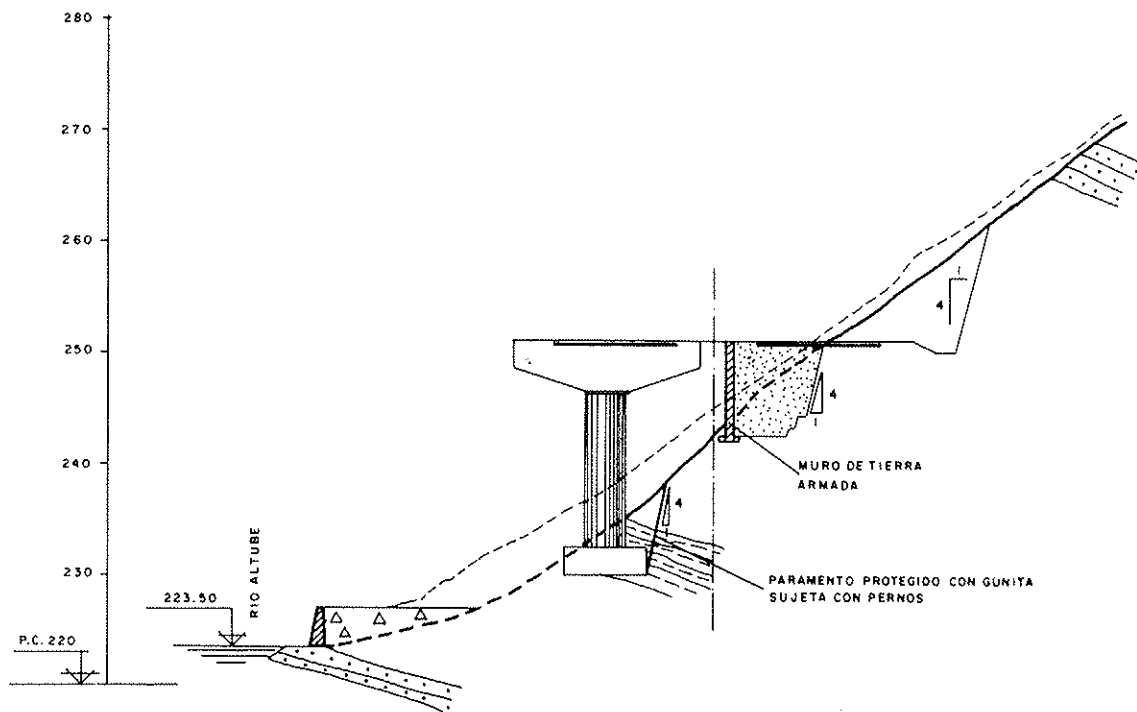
Sección mixta en viaducto y tierra armada en la Autopista Bilbao-Zaragoza (cortesía de Autopista Vasco-Aragonesa Concesionaria Española).
